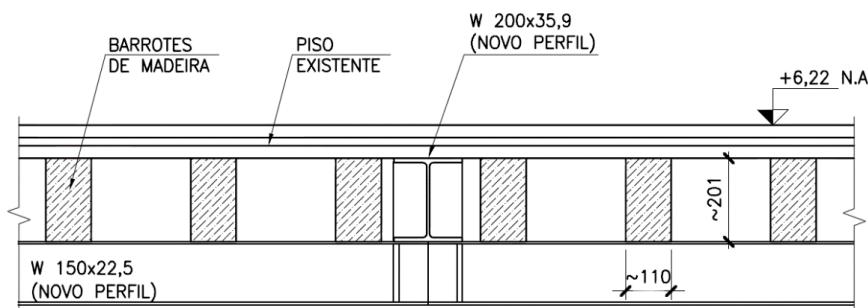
Corte esquemático do sistema de reforço do piso do colégio Eleva em Botafogo (antiga casa Daros), com dimensões em milímetros e elevações em metros.
